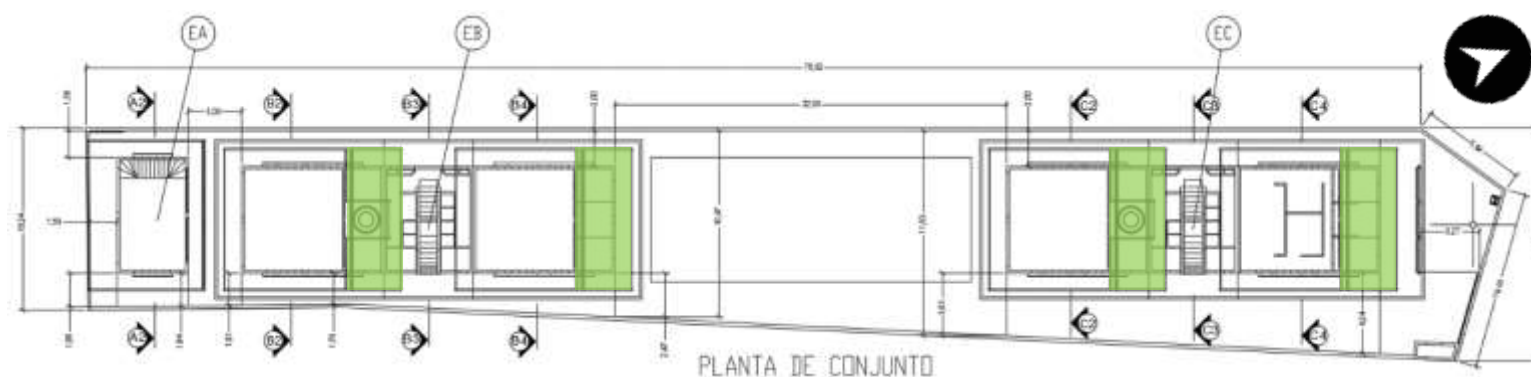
Plano planta de azoteas verdes. Fuente: Elaboración propia
